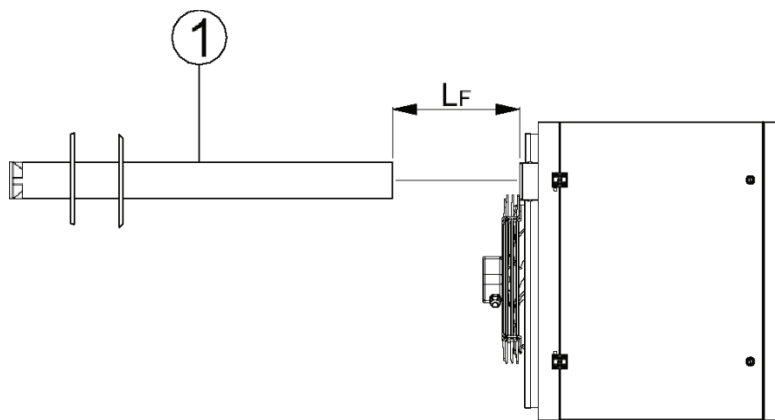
Conduits d'évacuation de type B23 muraux (sauf AG 85 et 100)
